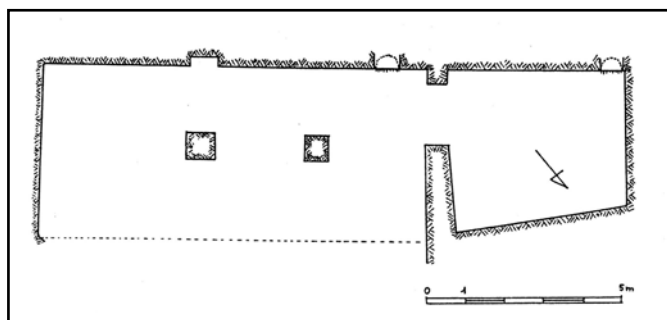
Sperlinga, planimetria della moschea rupestre a due pilastri centrali (grafica A. Messina).
